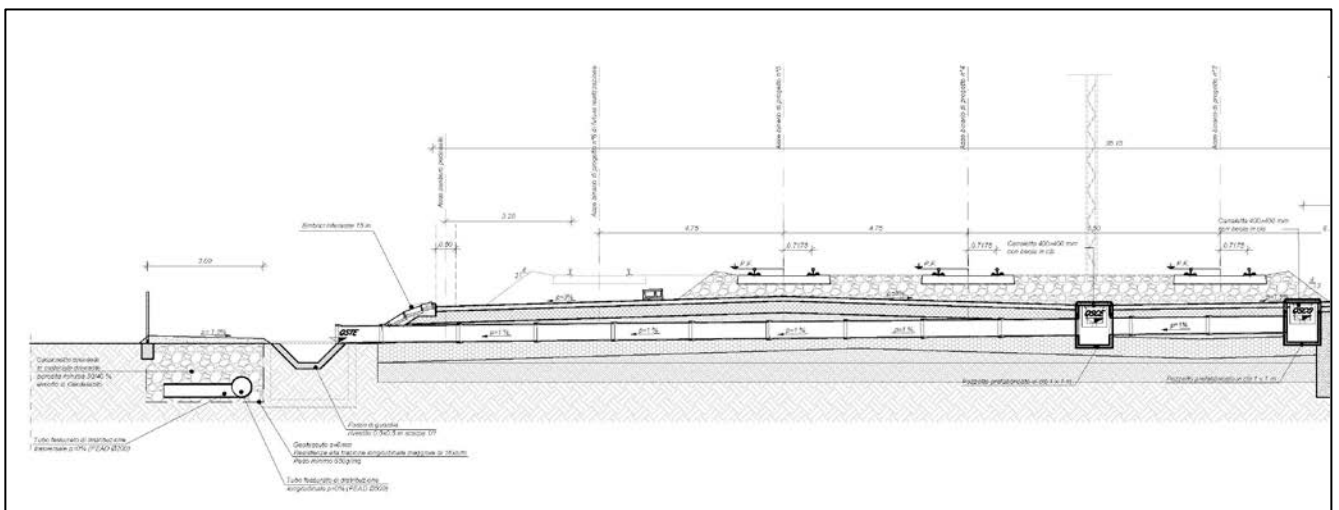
Stralcio planimetrico drenaggio tipologico di piattaforma
